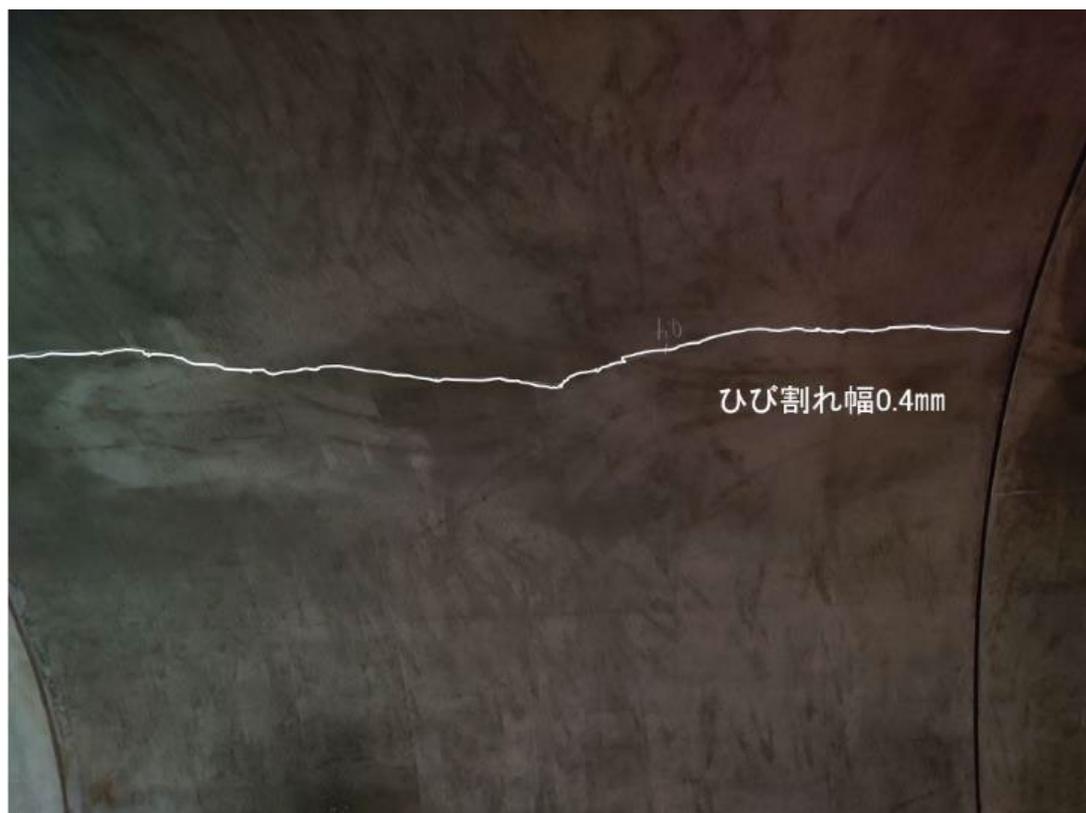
天端部に生じた縦断方向ひび割れ
